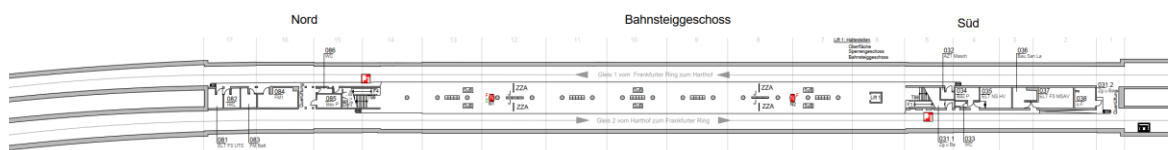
Grundriss Bahnsteig HA
